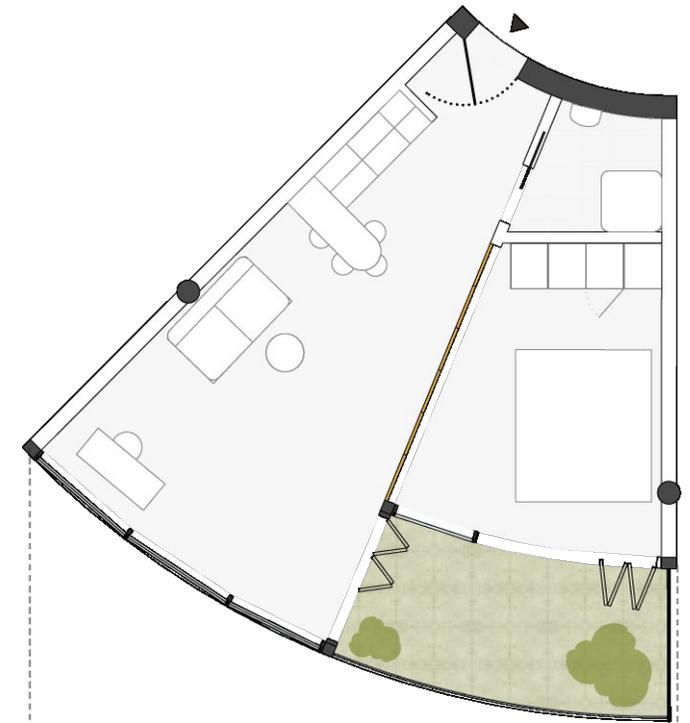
Grundriss Wohnung Typ A.b
